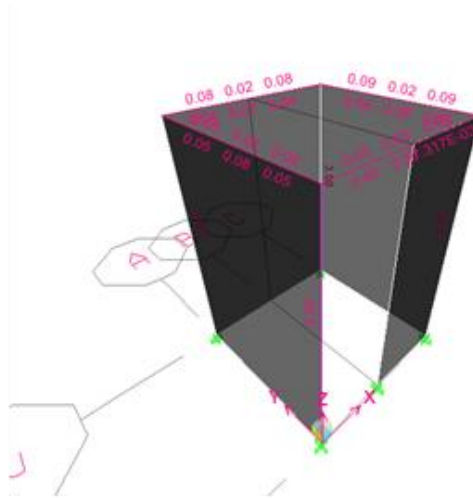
Cortante en la albañilería, dentro de lo permitido
